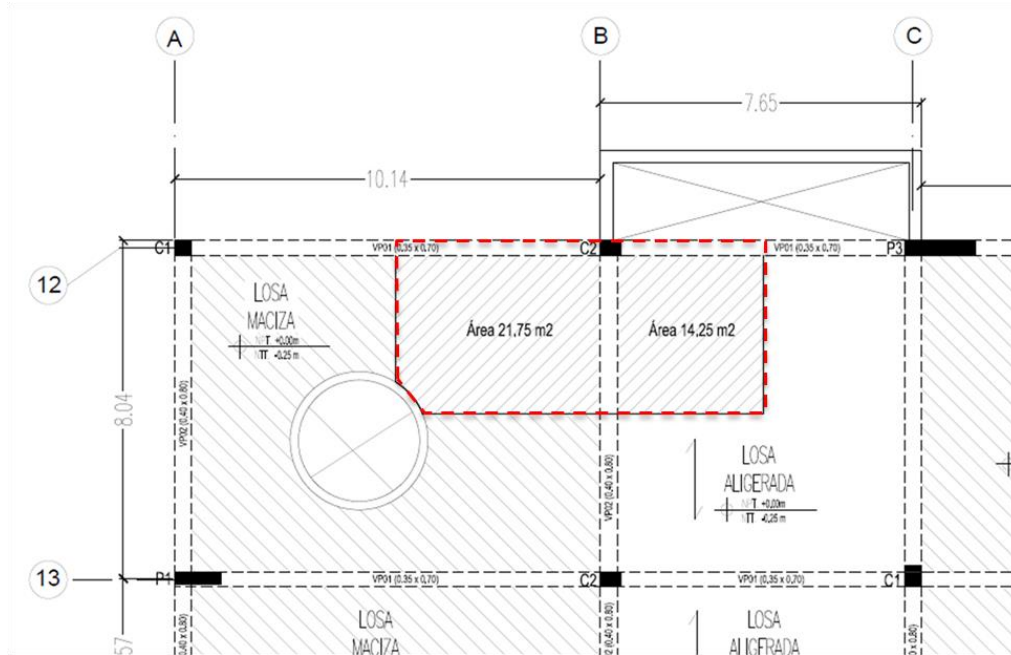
Área de influencia de columna C-1, en el primer piso.
